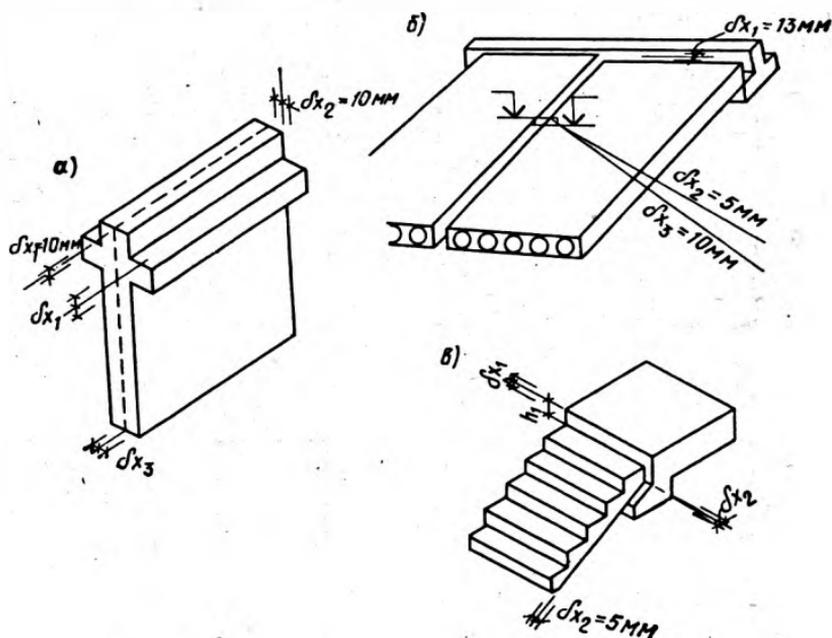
Контролируемые параметры и предельные отклонения при приемке: стеновых панелей (а); плит покрытий или перекрытий (б); лестничного марша и площадок (в)
